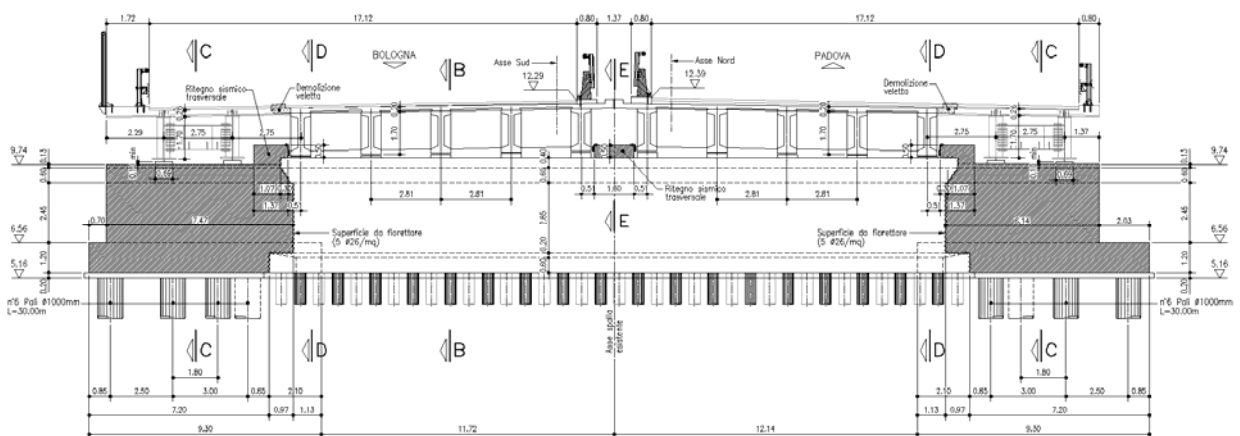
Prospetto pila con notazione ritegni trasversali (campate centrali)
